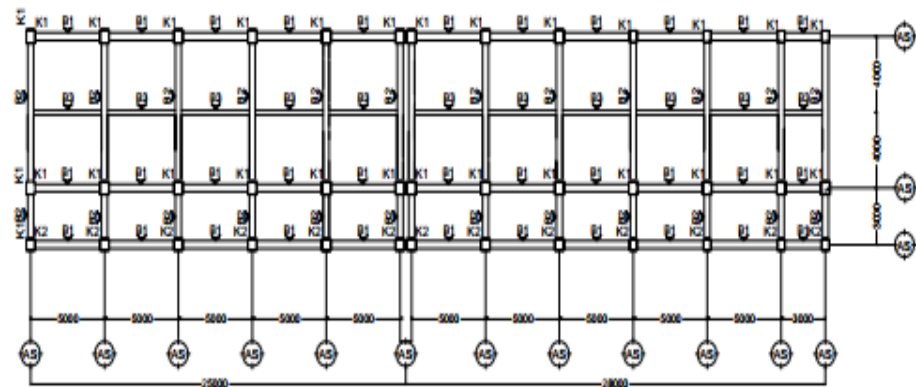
Rencana Balok dan Kolom Lantai 3
